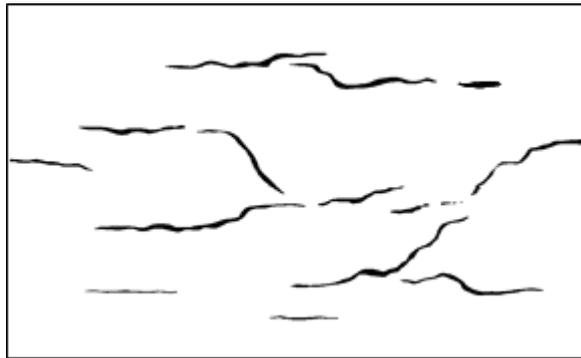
“Típica fisuración por retracción plástica (Price, 1982)”
